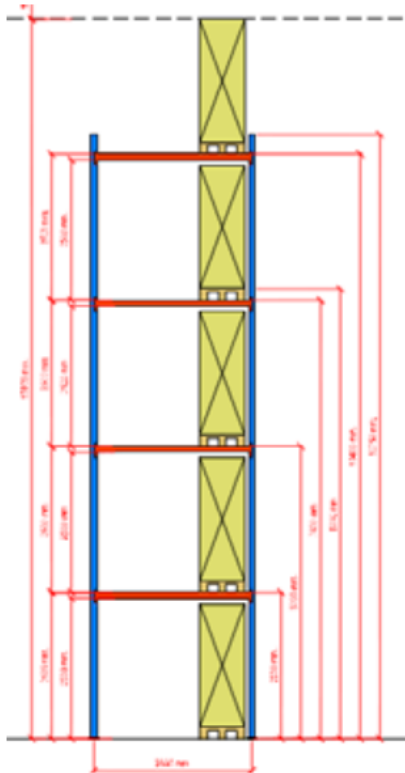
Detalle del alzado de los módulos de paletización Fuente Elaboración propia
